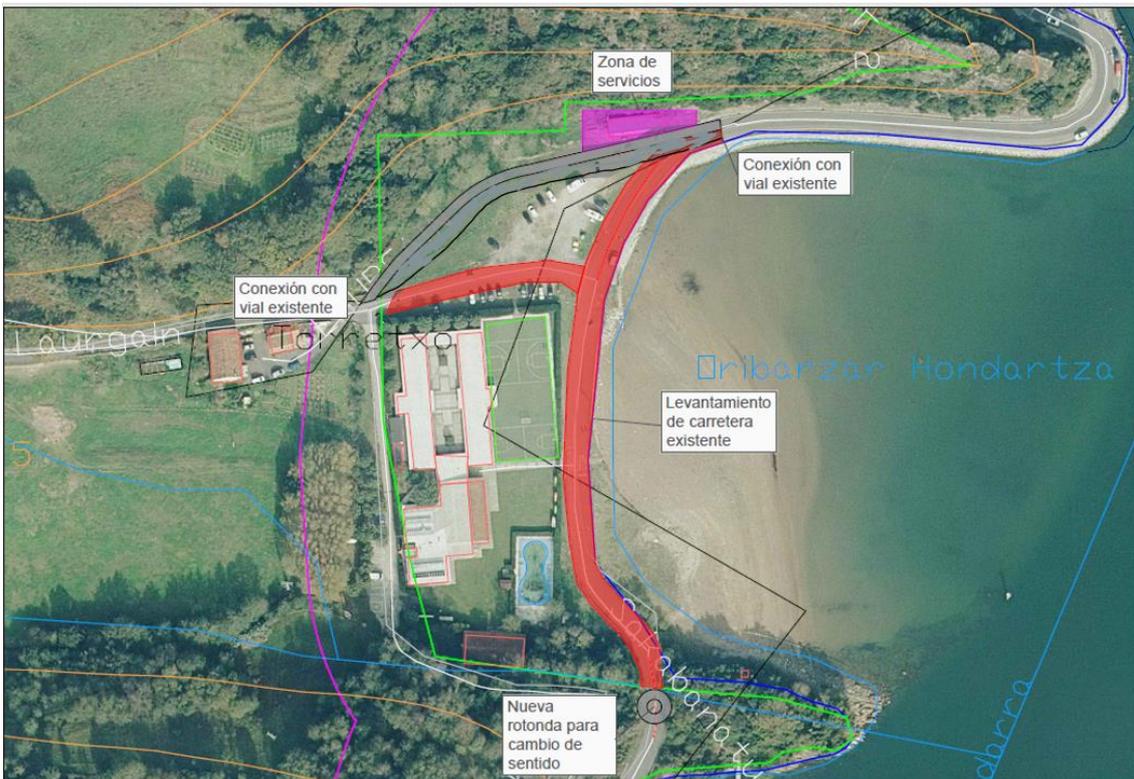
Trazado propuesto para la Alternativa 3. Fuente: elaboración propia.
